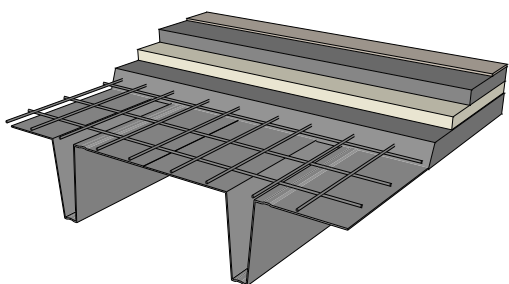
Konstruktionsschema Hoesch Additiv Decke
